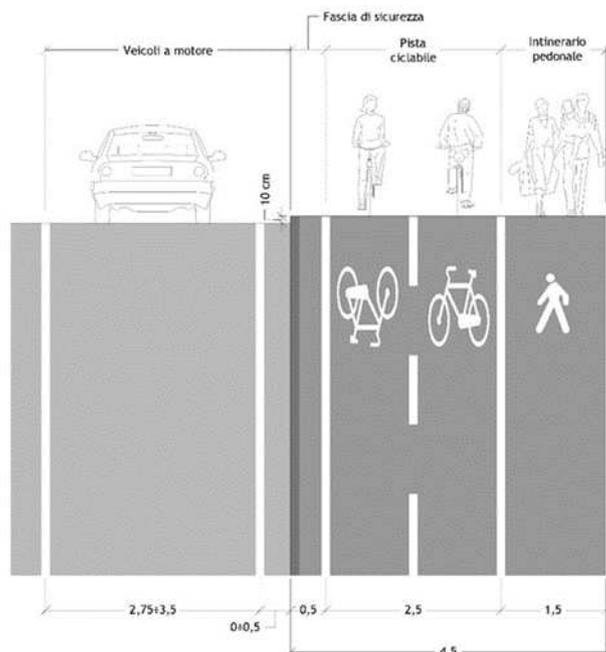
Sezione tipo: Pista ciclabile su corsia riservata sui marciapiedi
